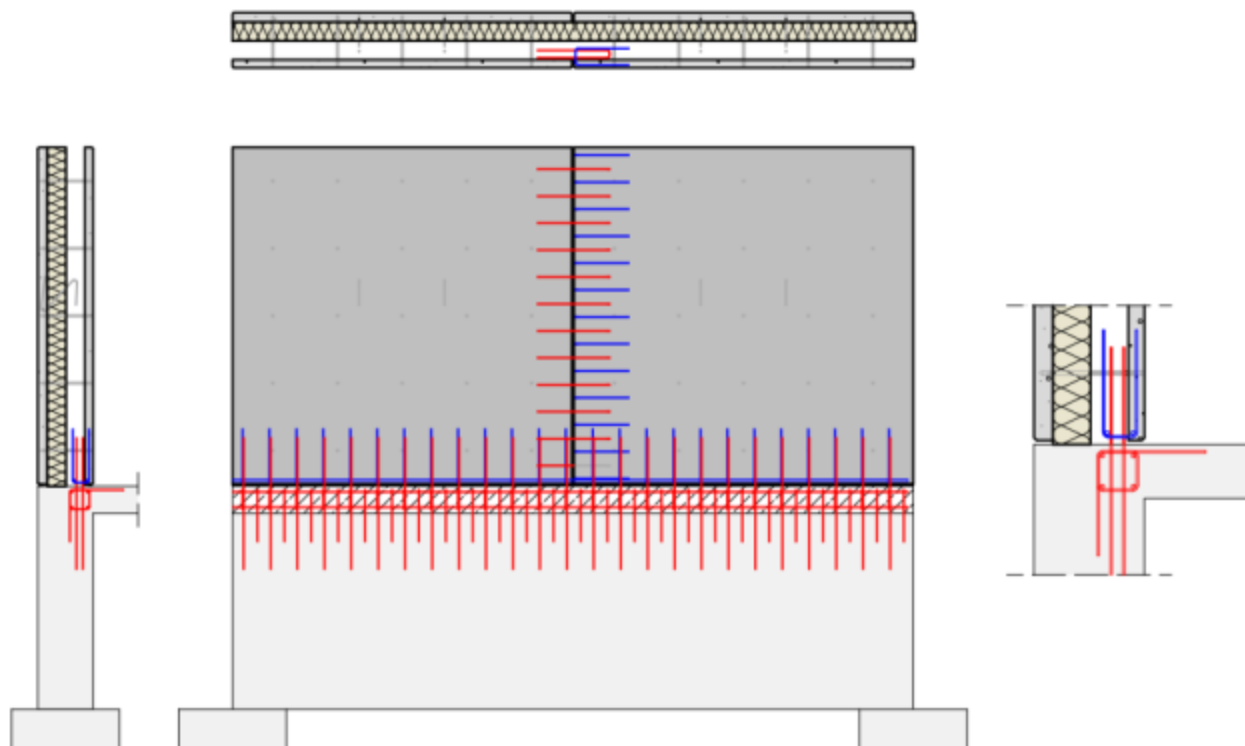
poutre-voile reprenant la dalle – tirant dans l' (i) Prémur A2C
